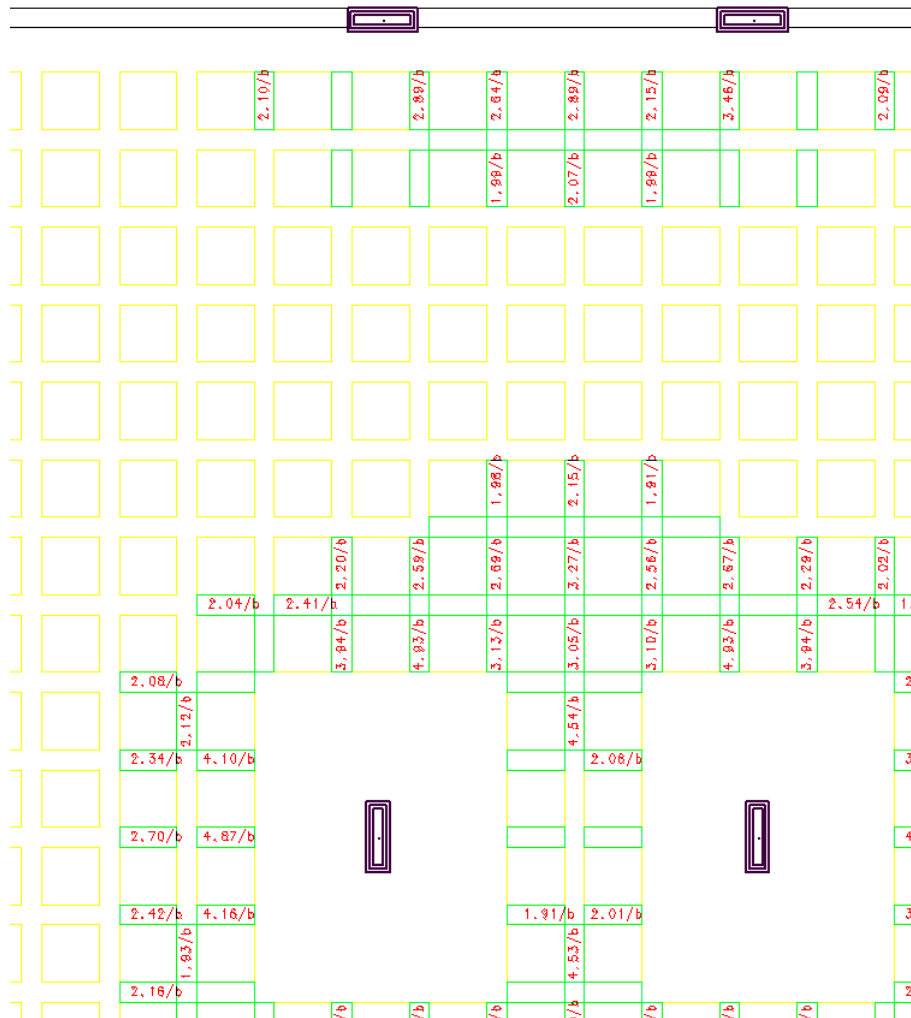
13 - Detalhe das faixas de armadura de cisalhamento – L205.
